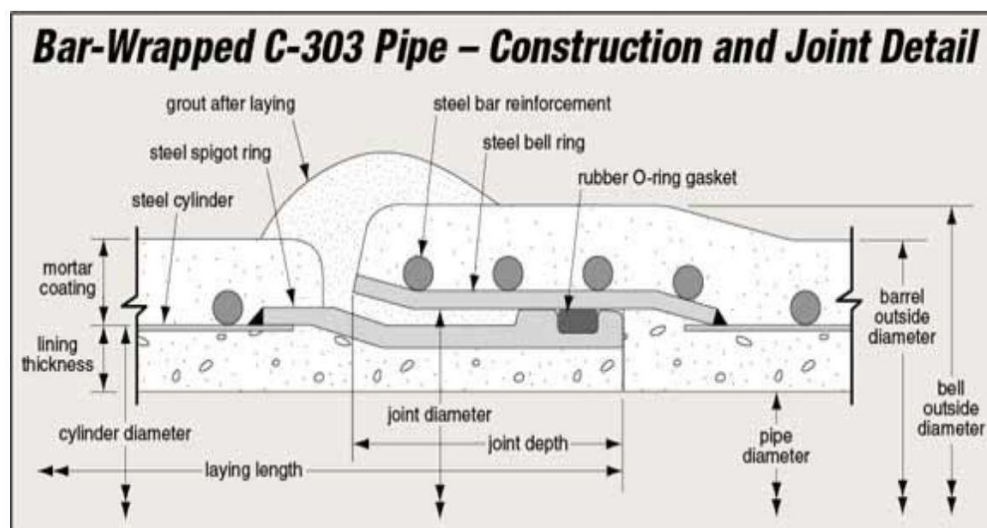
Detalle de Unión o Junta constructiva para CCP (Fuente: AWWA Manual M9)
